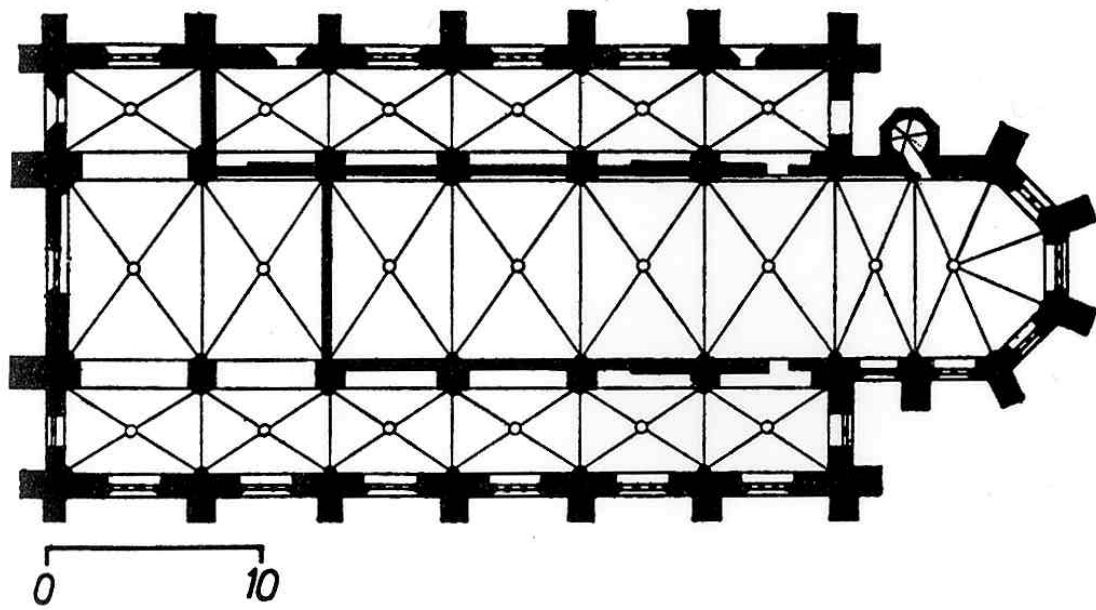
Grundriss St. Nikolai, Kiel, 1867
